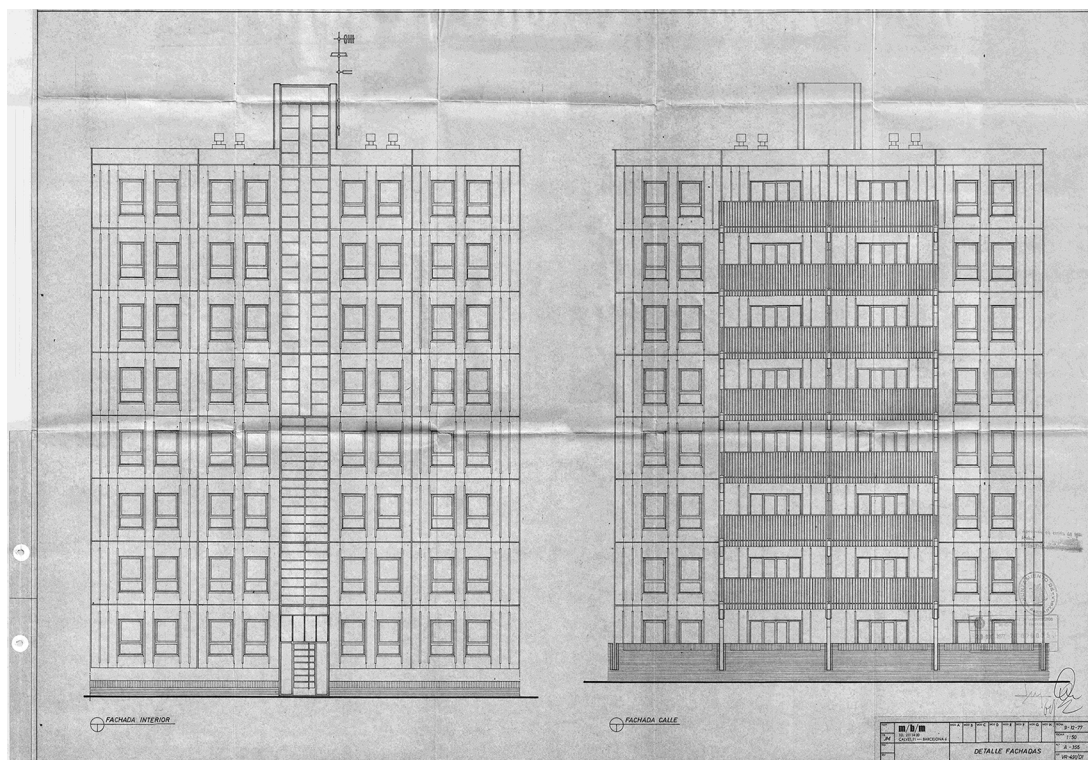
Conjunto de Cerdanyola, MBM: detalle de fachada (proyecto definitivo). Arxiu Municipal Cerdanyola del Vallès
